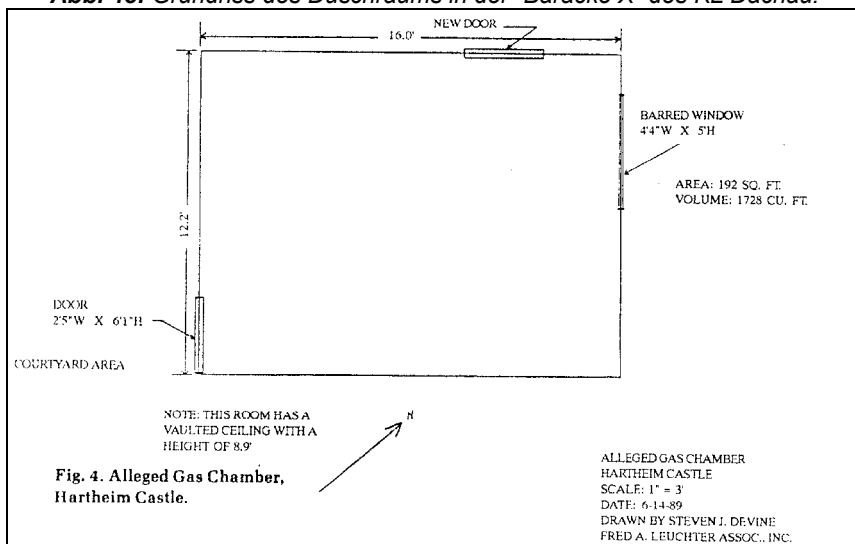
Grundriss der angeblichen Gaskammer im Schloss Hartheim, Österreich.
